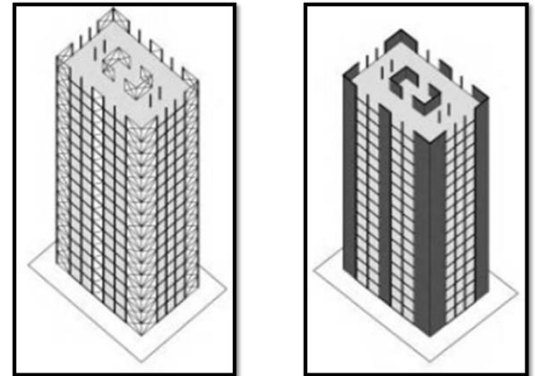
Schématisation d'un bâtiment en cadre rigide avec et sans les murs de contreventement
